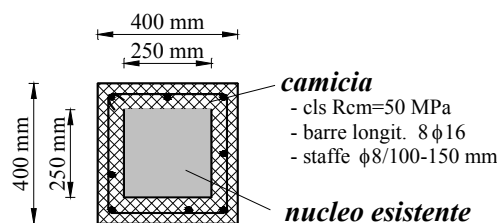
Sezione di un pilastro modificata dalla camicia in c.a.
